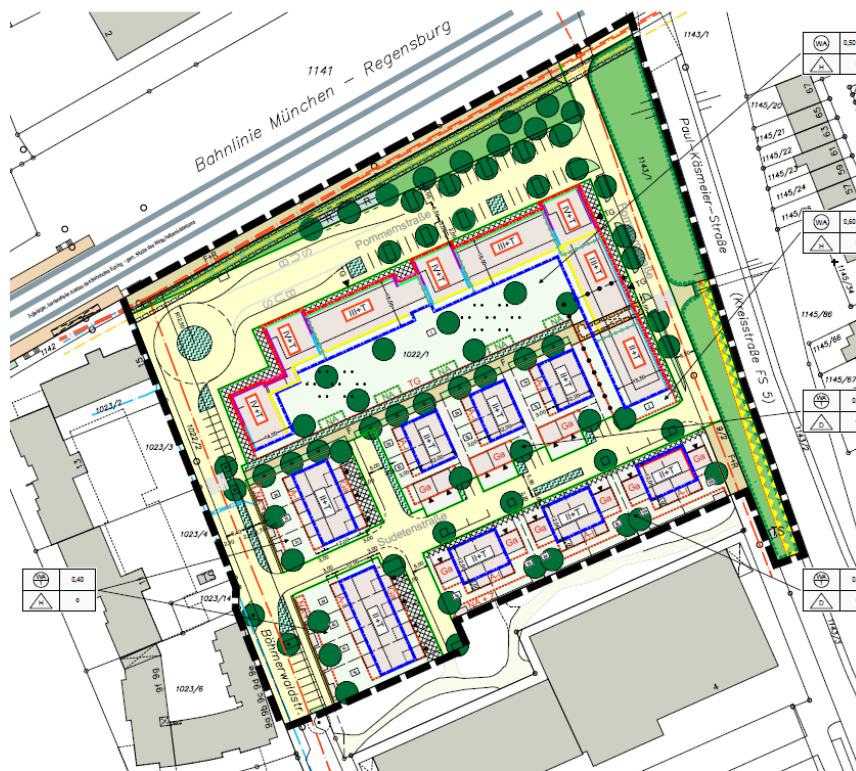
Bebauungsplan Böhmerwaldstraße.
